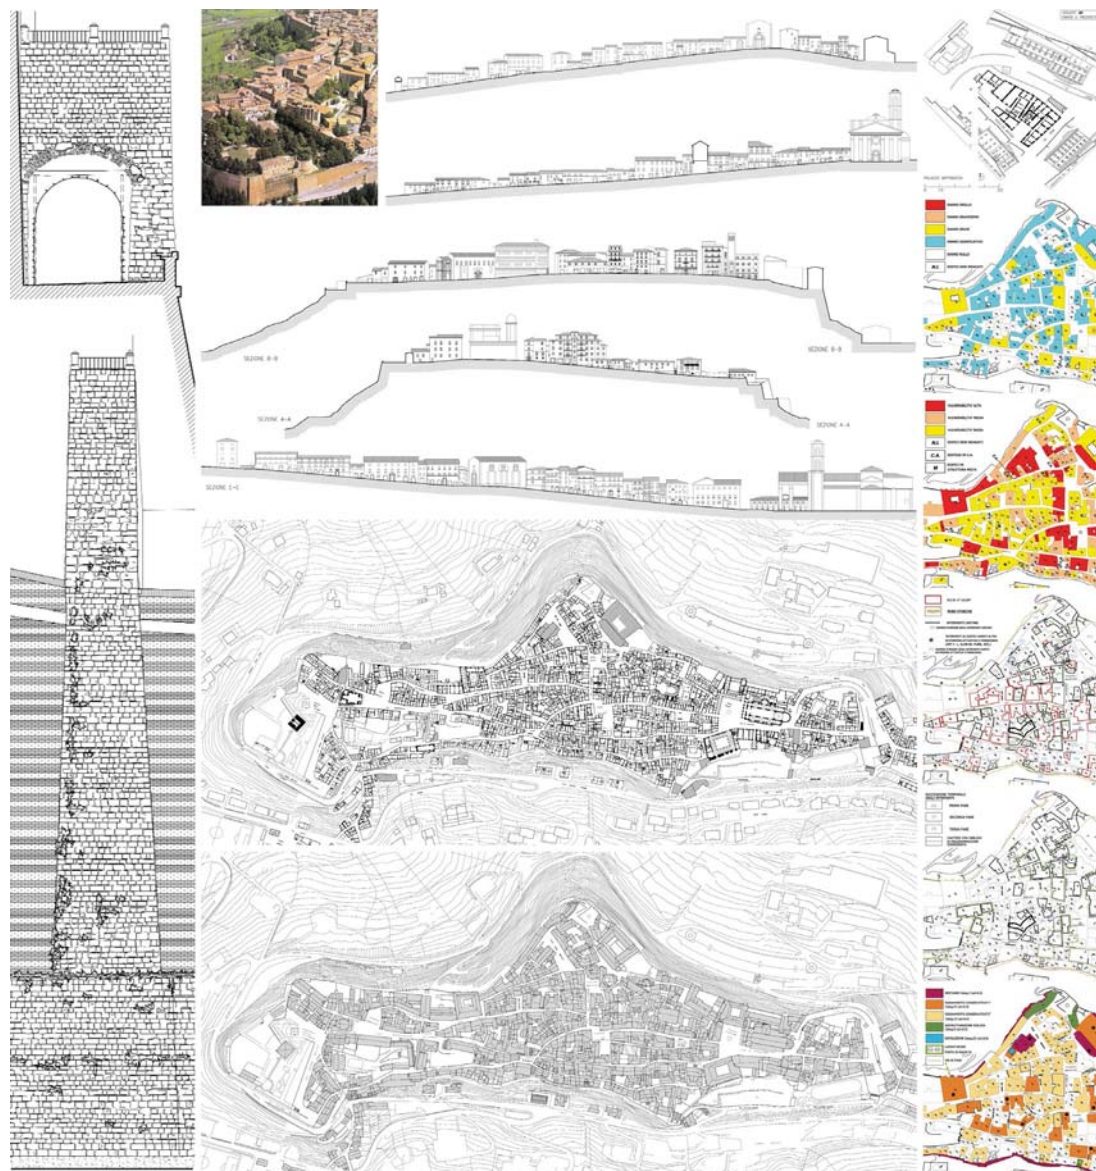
Planimetria del Piano Particolareggiato del centro Storico di Camerino, 1998.
